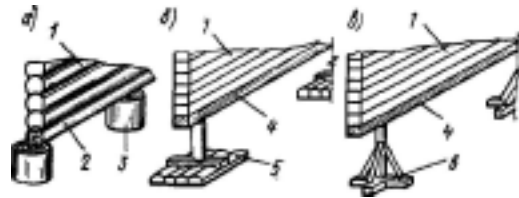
Конструктивные схемы столбчатых деревянных фундаментов:
